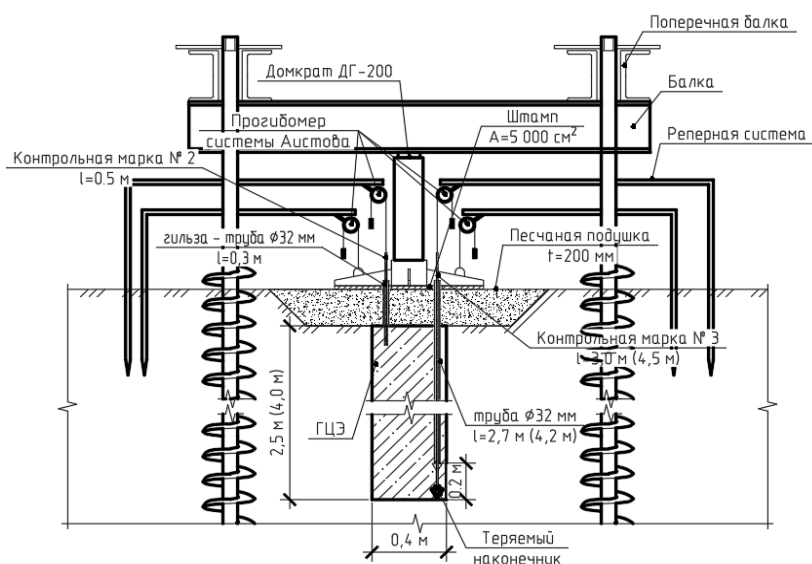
Схема установки для испытания плоским штампом армированного грунтового массива
